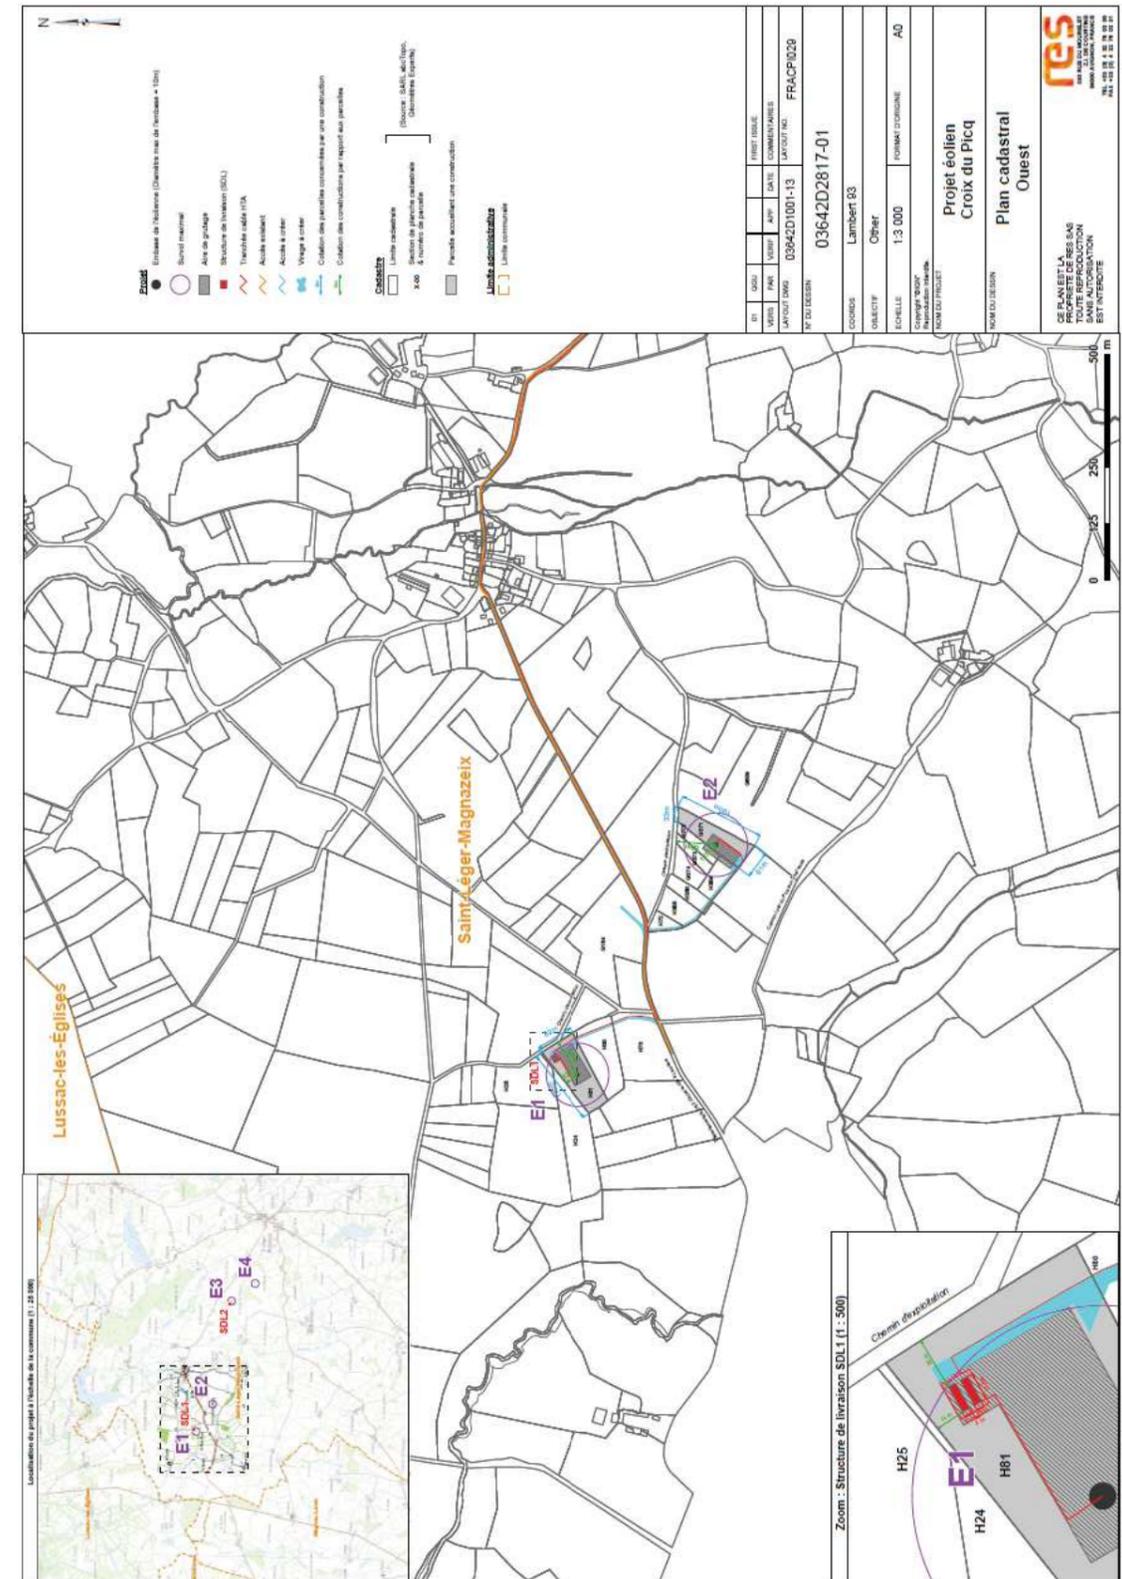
Plan cadastral de la ZIP Ouest (Source :RES)
